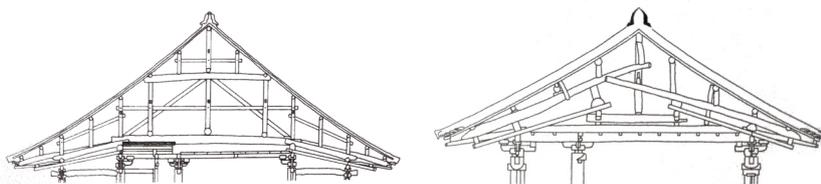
y 3.8. Estructura interior clásica de las cubiertas japonesas.
